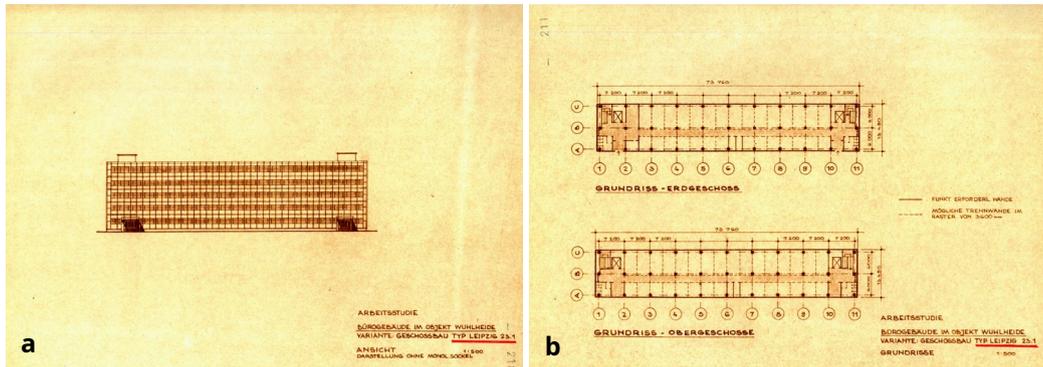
Richard Paulick, Arbeitsstudie Bürogebäude im Objekt Wuhlheide, Variante »Geschossbau Typ Leipzig 23.1«. a: Ansicht ohne monolithischen Sockel, Maßstab 1:500, 1974; b: Grundrisse, Maßstab 1:500, 1974.
